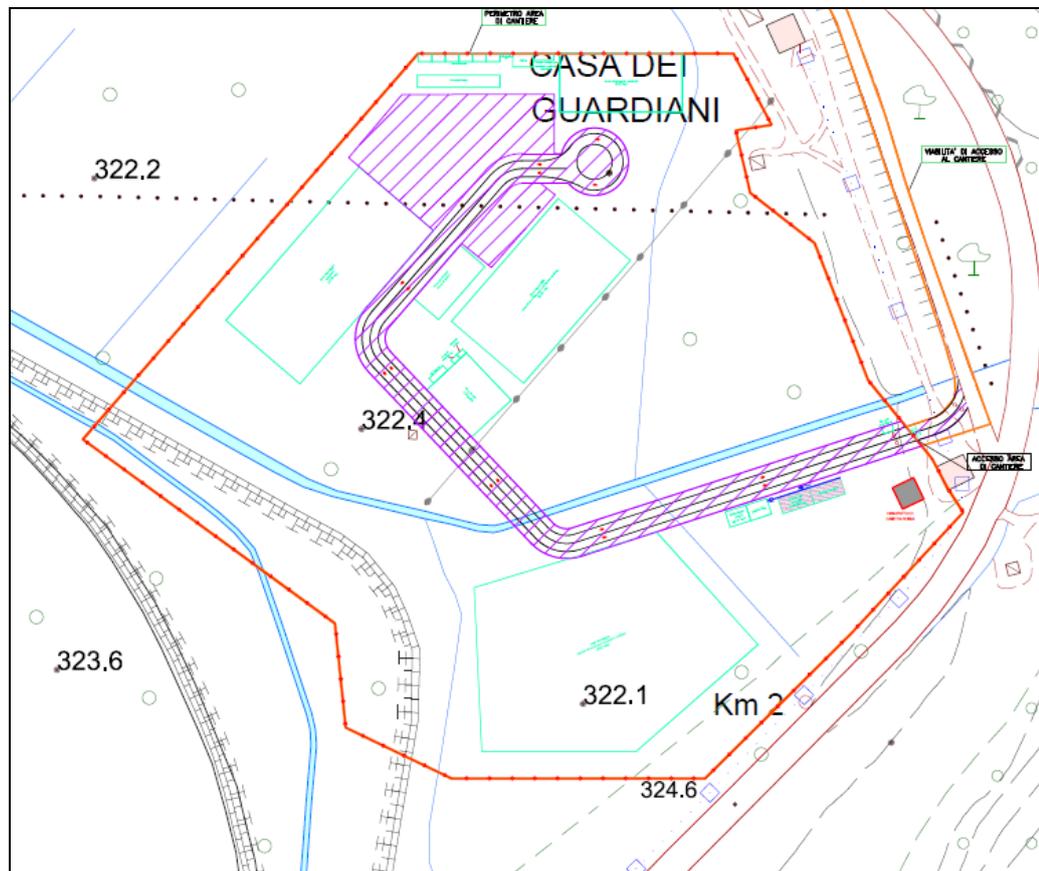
Stralcio planimetrico area di cantiere Manufatto di Casetta Rossa
